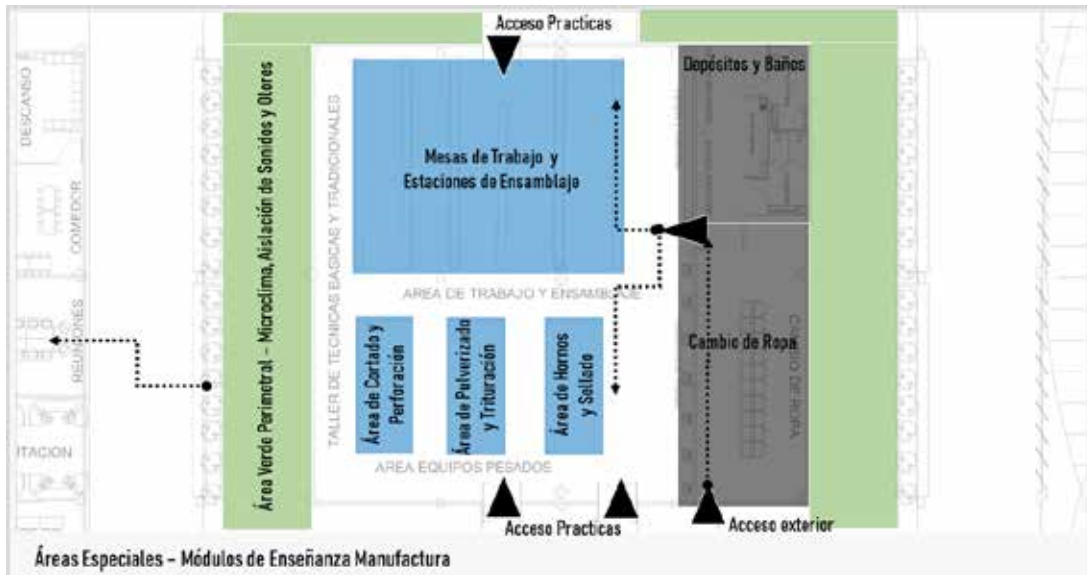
Detalle de Área. Módulo de Manufactura. Fuente: Schaverin (2021)
